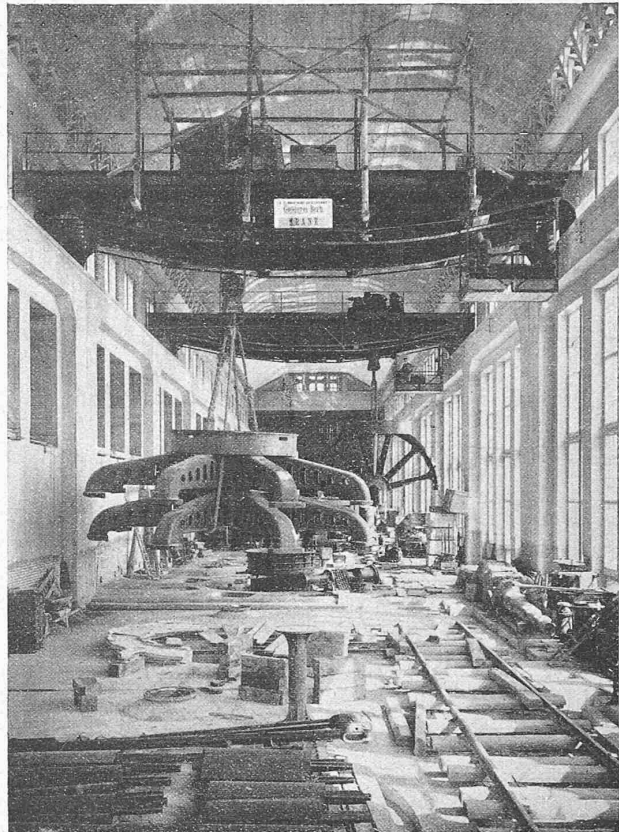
Inneres des Maschinenhauses Gösgen während der Montage der Maschinen (Belastungsprobe der Krane). 26. VIII. 1917.
